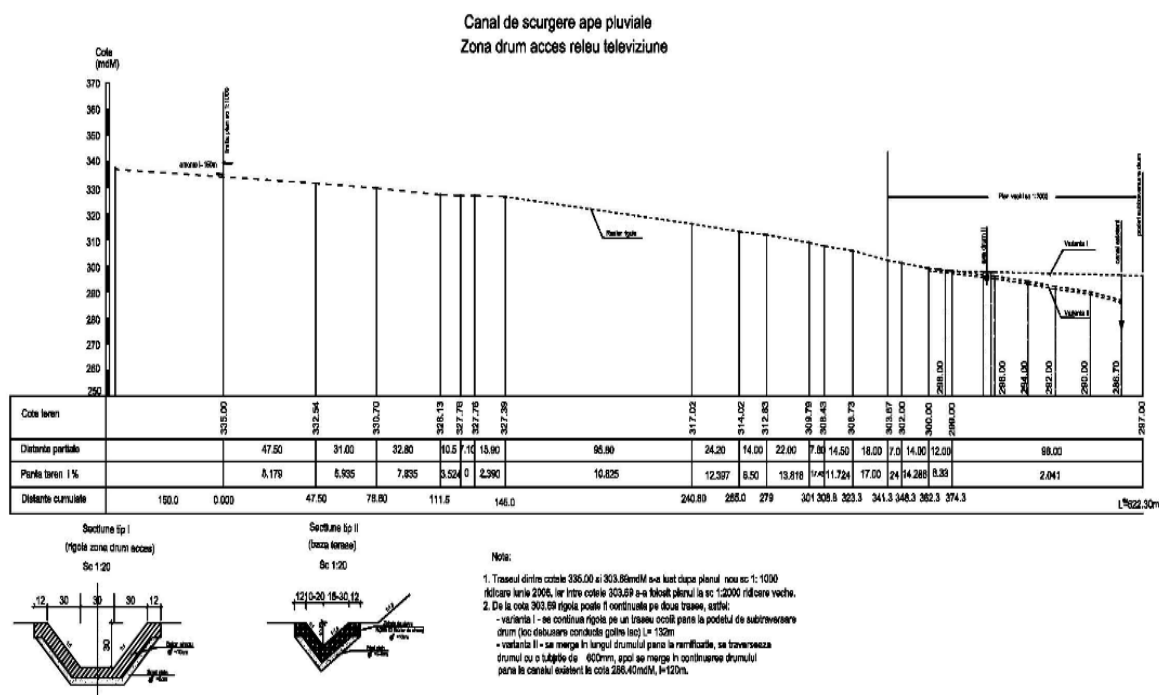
Profil longitudinal al canalului de scurgere ape pluviale
